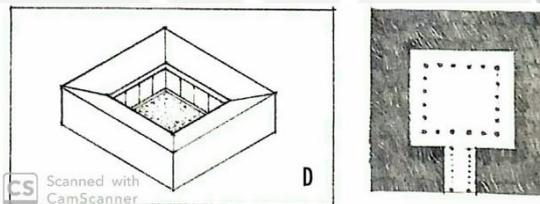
2 Sketsa dan Layout Ruang B
